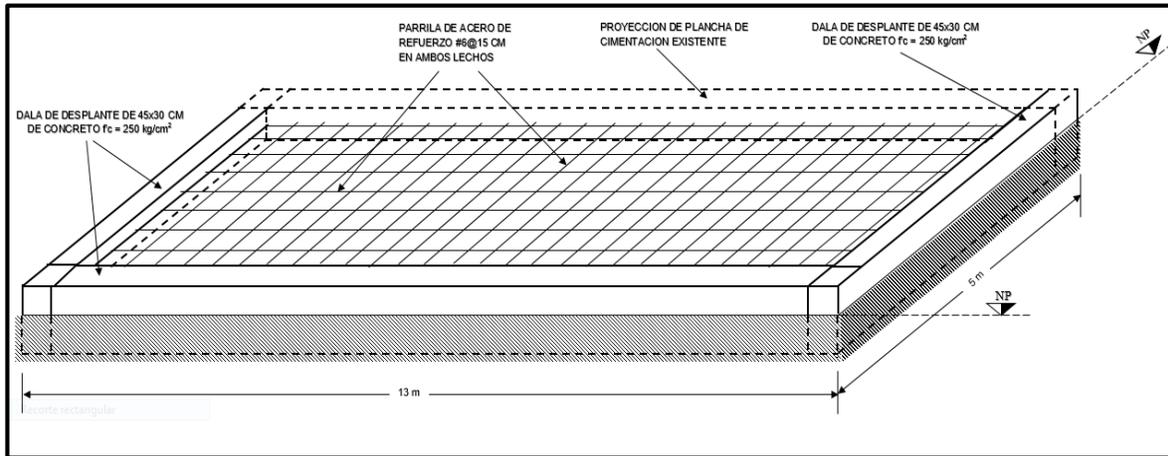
Detalle de plancha para firme de Cimentación de la Ampliación de la Caseta
